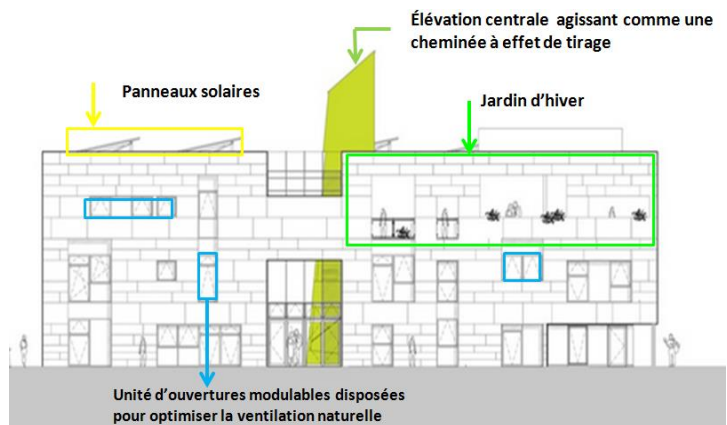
Elevation EST One Trinity green Source : Archdaily.com traité par auteur
